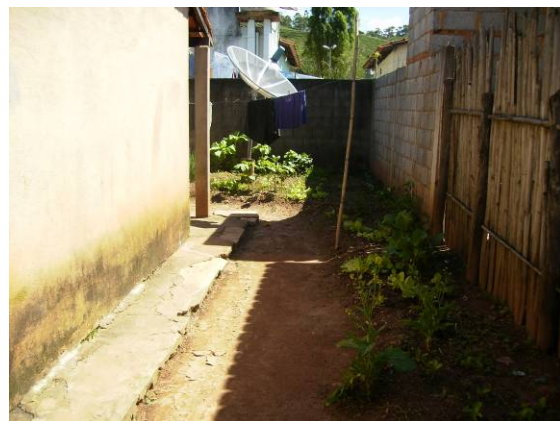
Edificação de muros e cercas de forma a delimitar terrenos vizinhos
